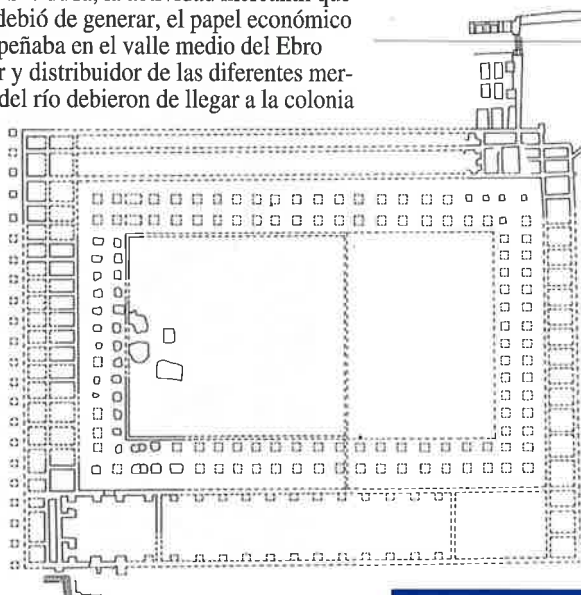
Planta del Foro de la plaza de La Seo en época de Tiberio. Reconstrucción
